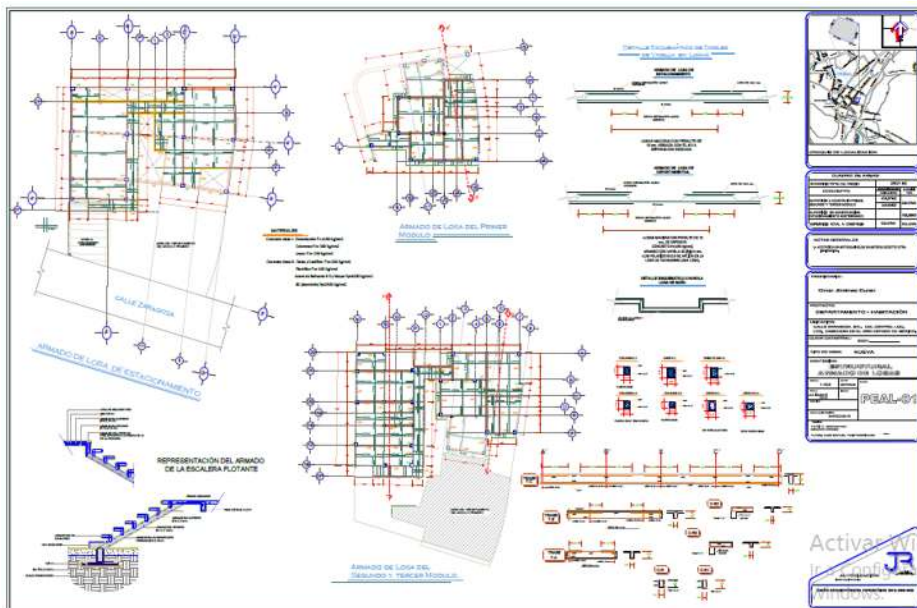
Imagen del plano de armado de losa, donde se especifica la propuesta de tipo de configuración de la estructura de las losas, donde queda interpretado la distancia de las bayonetas, las trabes de cerramiento, tanto en el estacionamiento subterránea, como en los tres módulos de departamentos, el detalle esquemático de la charola de la losa de baño, como las especificaciones de la resistencias de los materiales, sin dejar de mencionar la propuesta del armado de la escalera de servicio.
